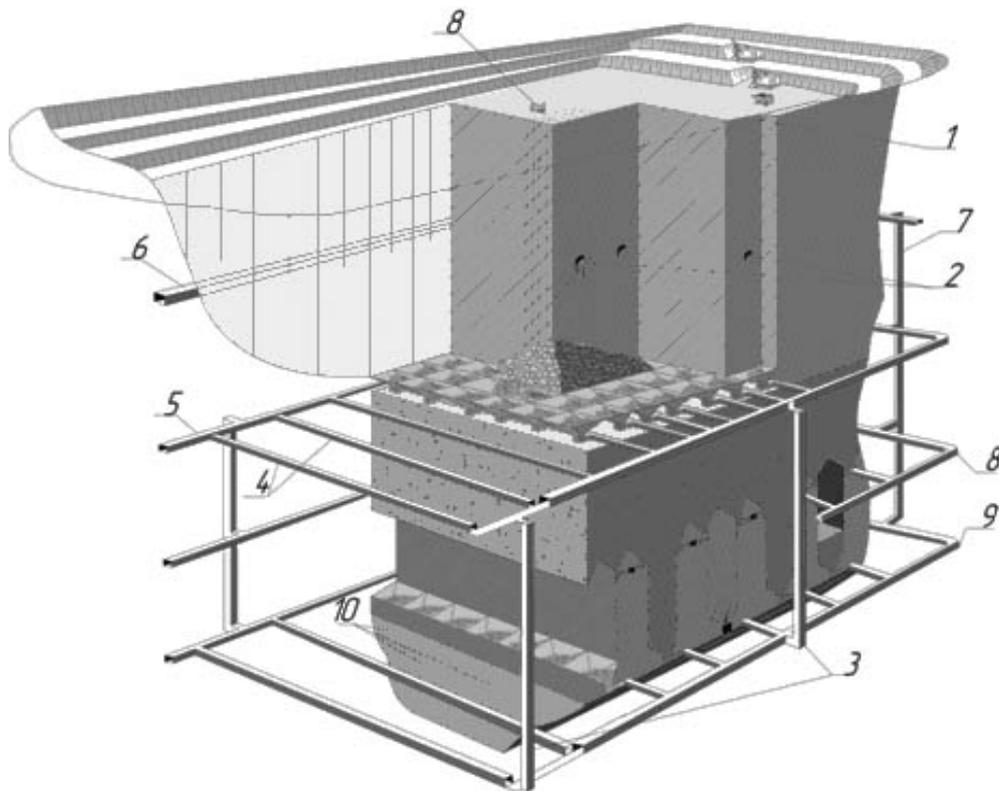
Четырехъярусная горнотехническая система с последовательной отработкой запасов открытого, открыто-подземного, подземного и скважинного ярусов: 1 – дно карьера, 2 – выработки бурового горизонта в ОПЯ, 3 – рудоспуски, 4 – вентиляционно-закладочный орт, 5 – кольцевой штрек в основании ОПЯ, 6 – подэтажный штрек ОПЯ, 7 – вентиляционно-ходовой восстающий, 8 – кольцевые штреки верхнего и нижнего горизонты шахты
